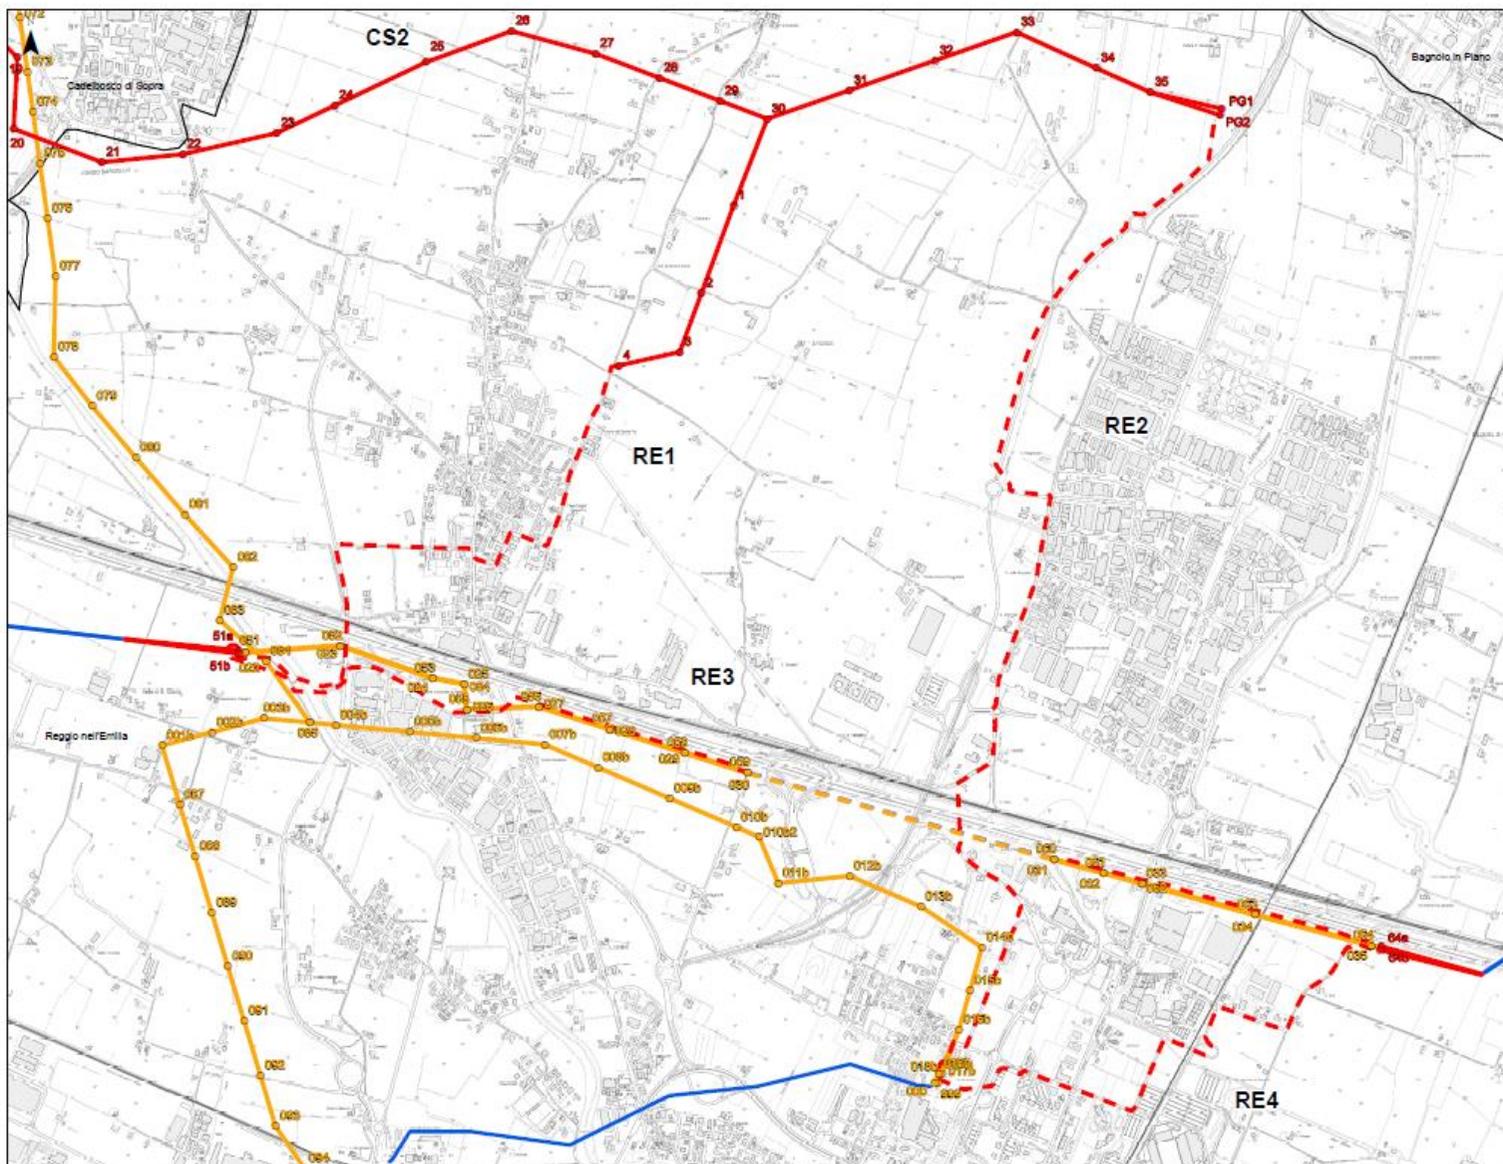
Planimetria progetto 31/01/2021 (tratta da elaborato Terna DU0000006B1937737)
